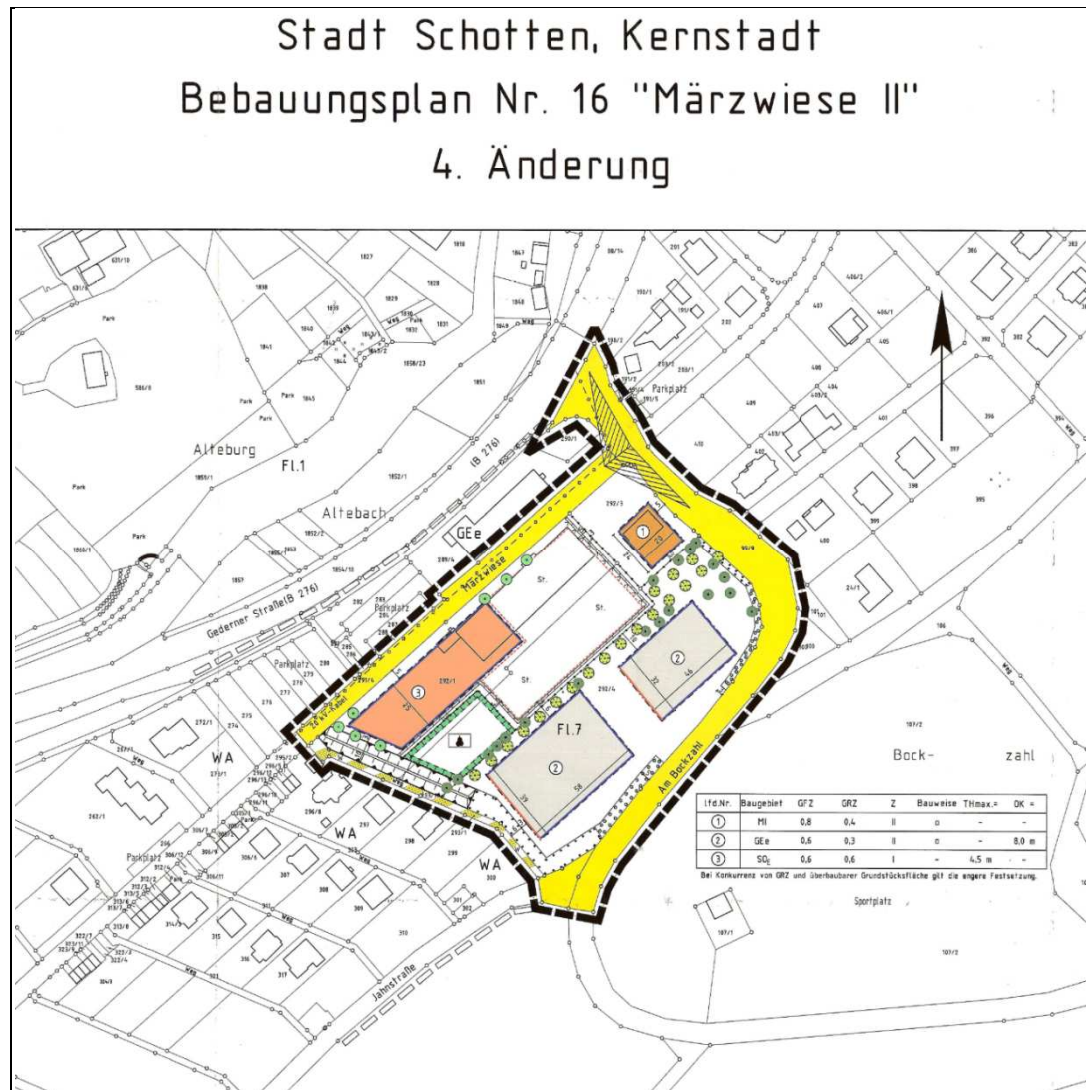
Bebauungsplan Schotten „Märzwiese II“ 4. Änderung.
